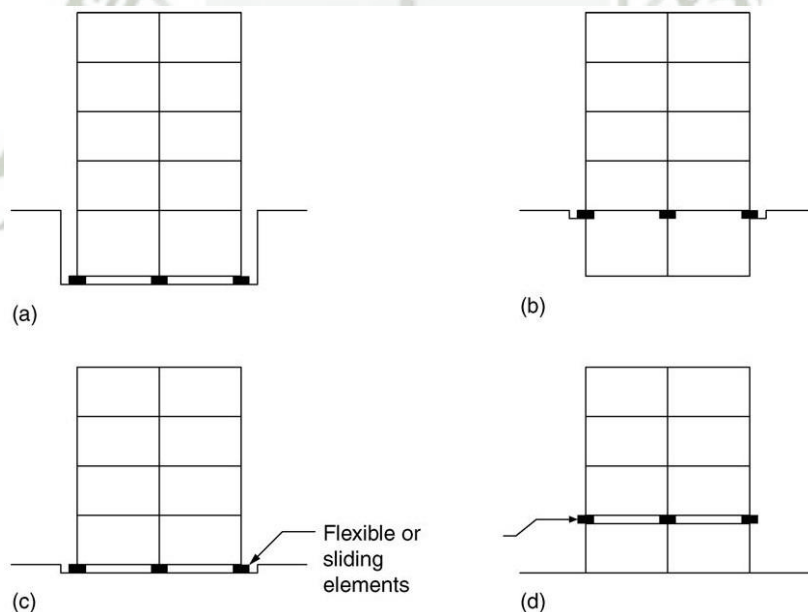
B: Posibles ubicaciones de dispositivos de aislamiento en edificios aislados en la base. (a) Parte inferior de las columnas del sótano, (b) parte superior de las columnas del sótano, (c) parte inferior de las columnas del primer piso, y (d) parte superior de las columnas del primer piso.
